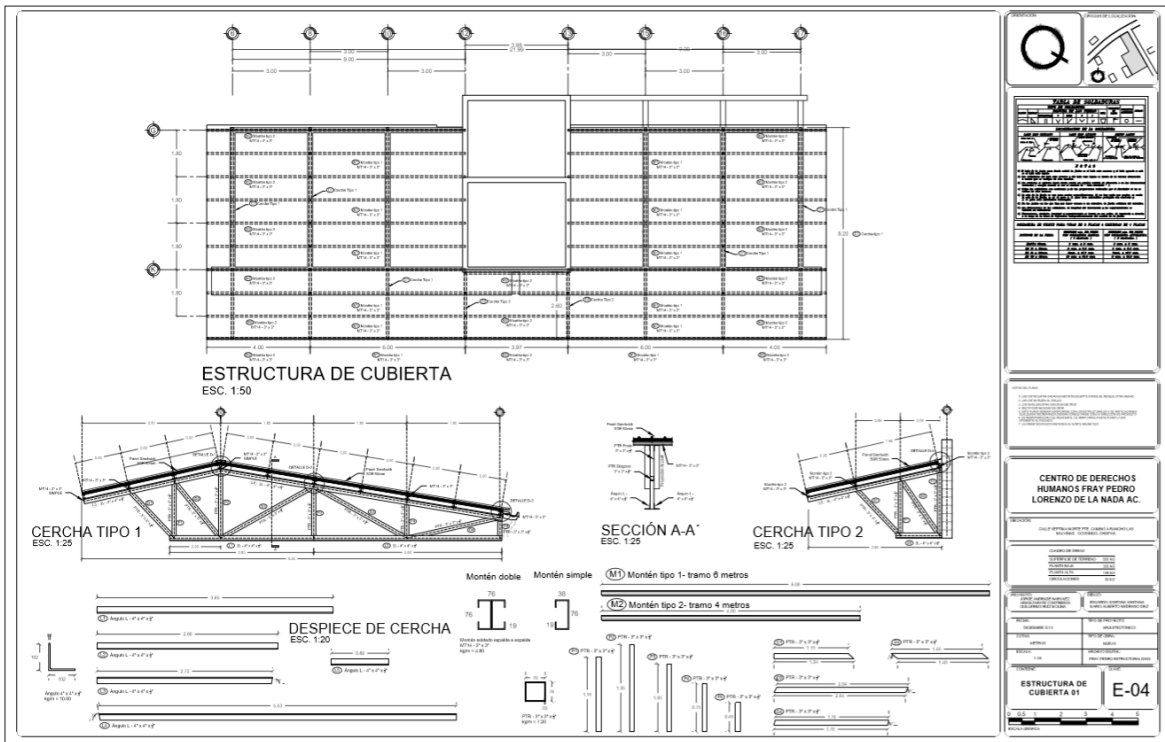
Estructura de cubierta 01. Elaboración propia.
